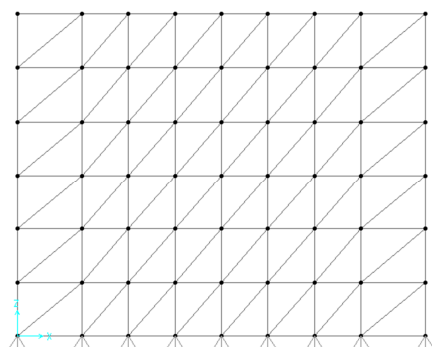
Configuração dos Planos de Contraventamento Vertical Com Elementos de Contraventamento Pequenos
